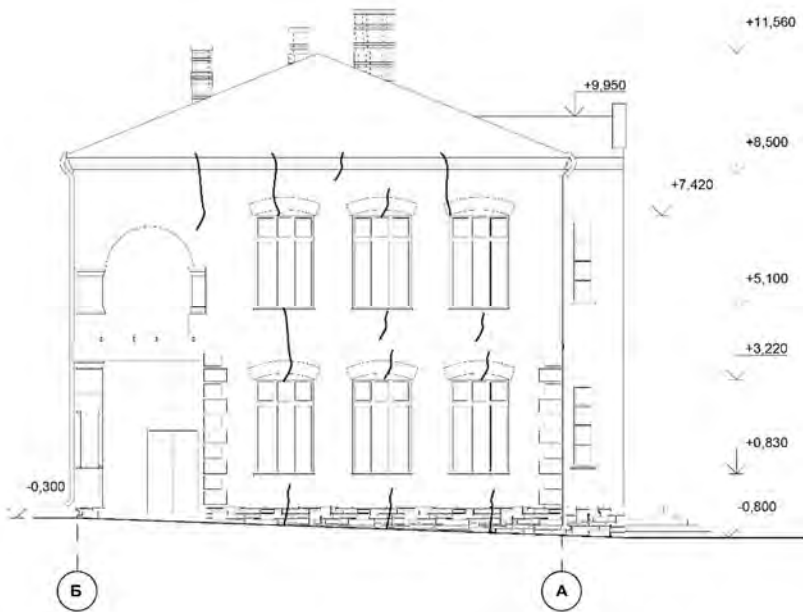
Фасад із нанесеними дефектами зсередини будівлі
